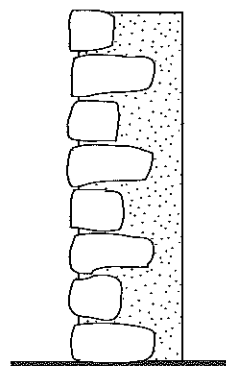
Maçonnerie de parement en pierres.
